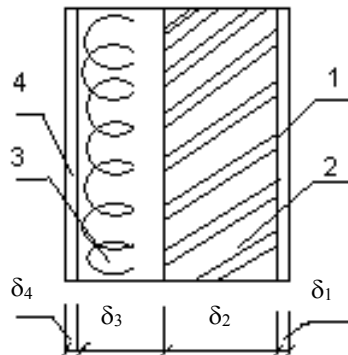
К примеру определения толщины утепляющего слоя наружной стены
